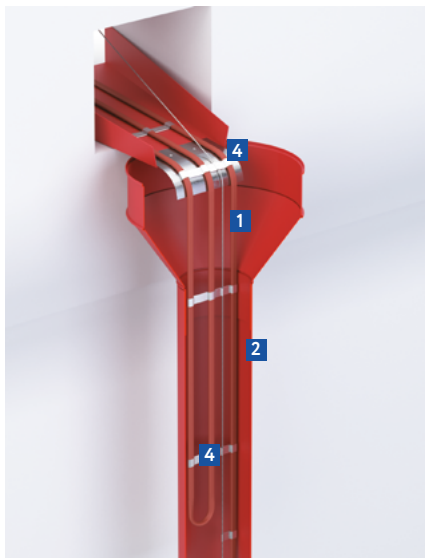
Типовой узел крепления нагревательных секций на водомете (плоская кровля)
